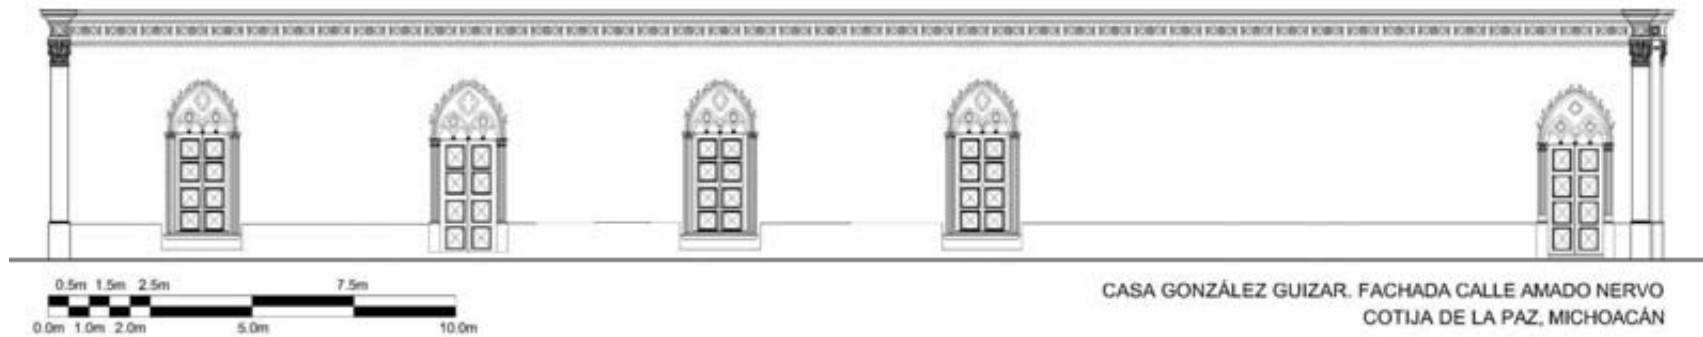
Posible reconstrucción de la fachada poniente de la casa González Guízar con sus aplanados
